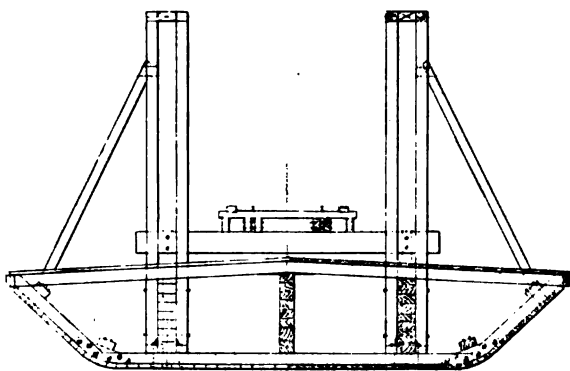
Coupe transversale du Pont-Ponton de Wabasha.
